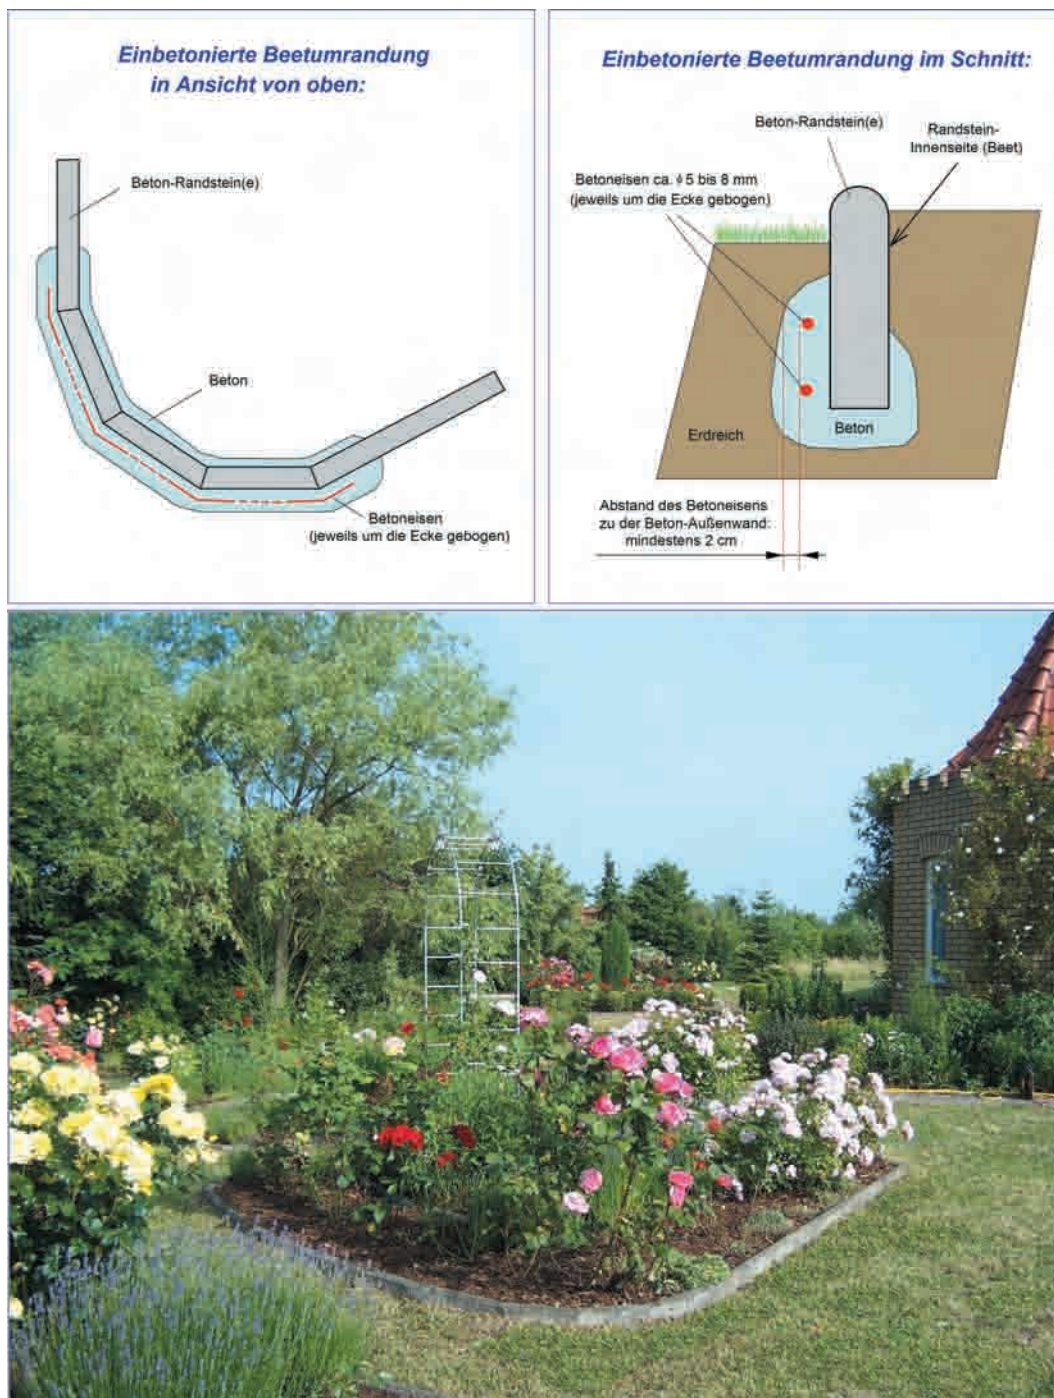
Sowohl der Betonsockel als auch das Betoneisen können unter den Ecken der Umrandungssteine durchlaufend (ununterbrochen) verlegt werden: oben zeichnerische Darstellung, unten Ausführungsbeispiel einer abgerundeten Rosenbeetumrandung.
